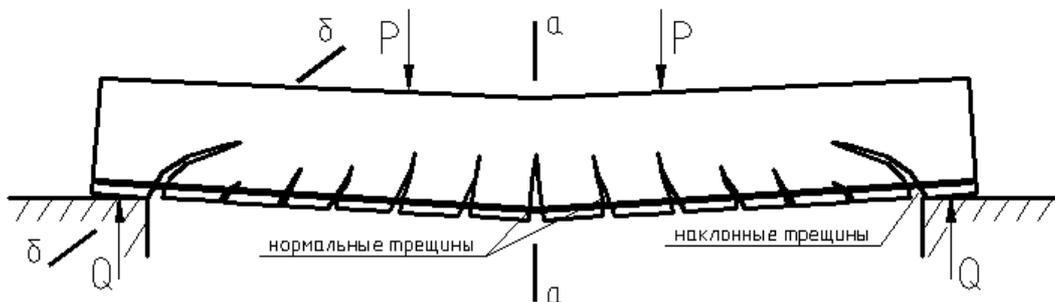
Схема изгибаемой железобетонной балки: a-a – нормальное сечение; б-б – наклонное сечение
